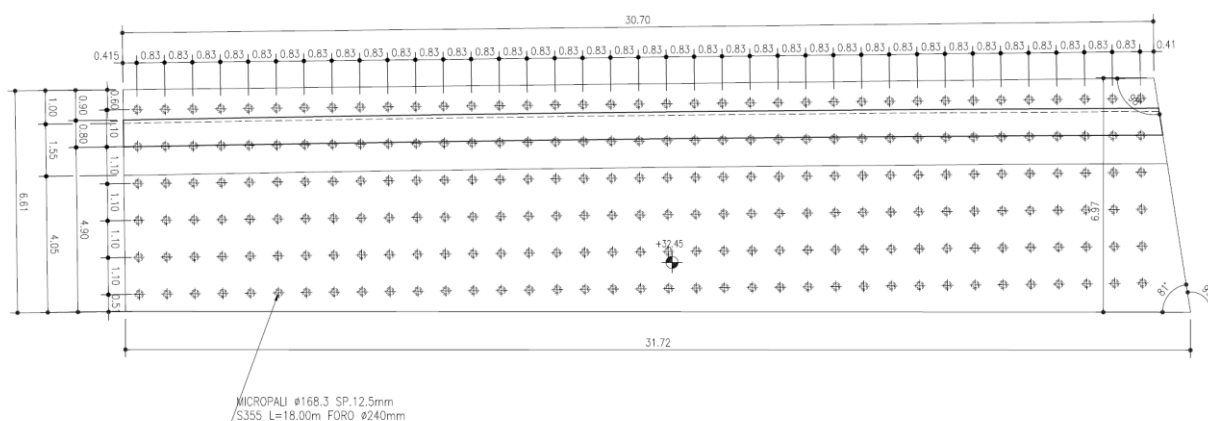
Muri d'ala carreggiata nord – Pianta Fondazioni
